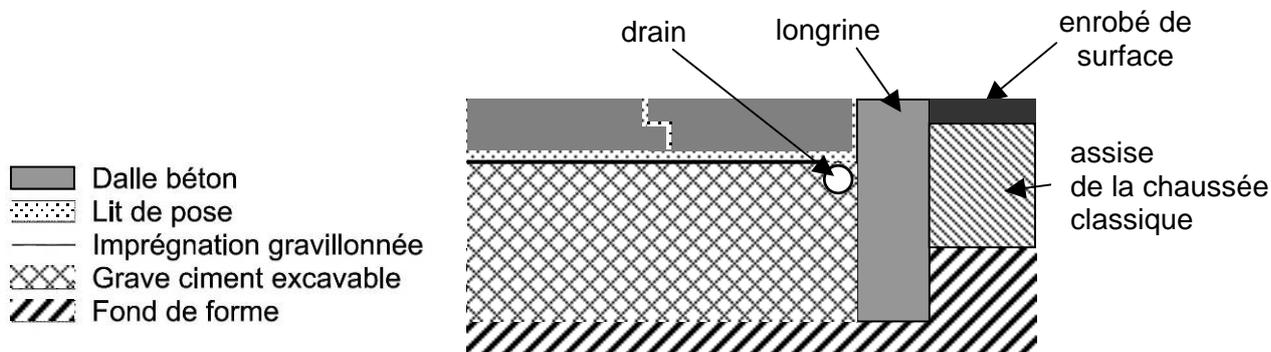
coupe longitudinale de principe d'une extrémité de CUD à dalles emboîtées.
